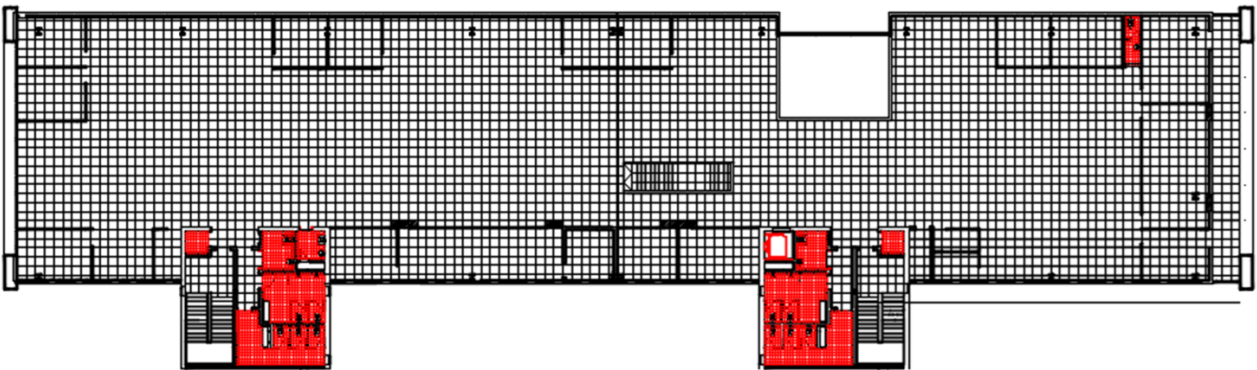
Lamina de planta arquitectónica de piso 1era planta propuesta 2
